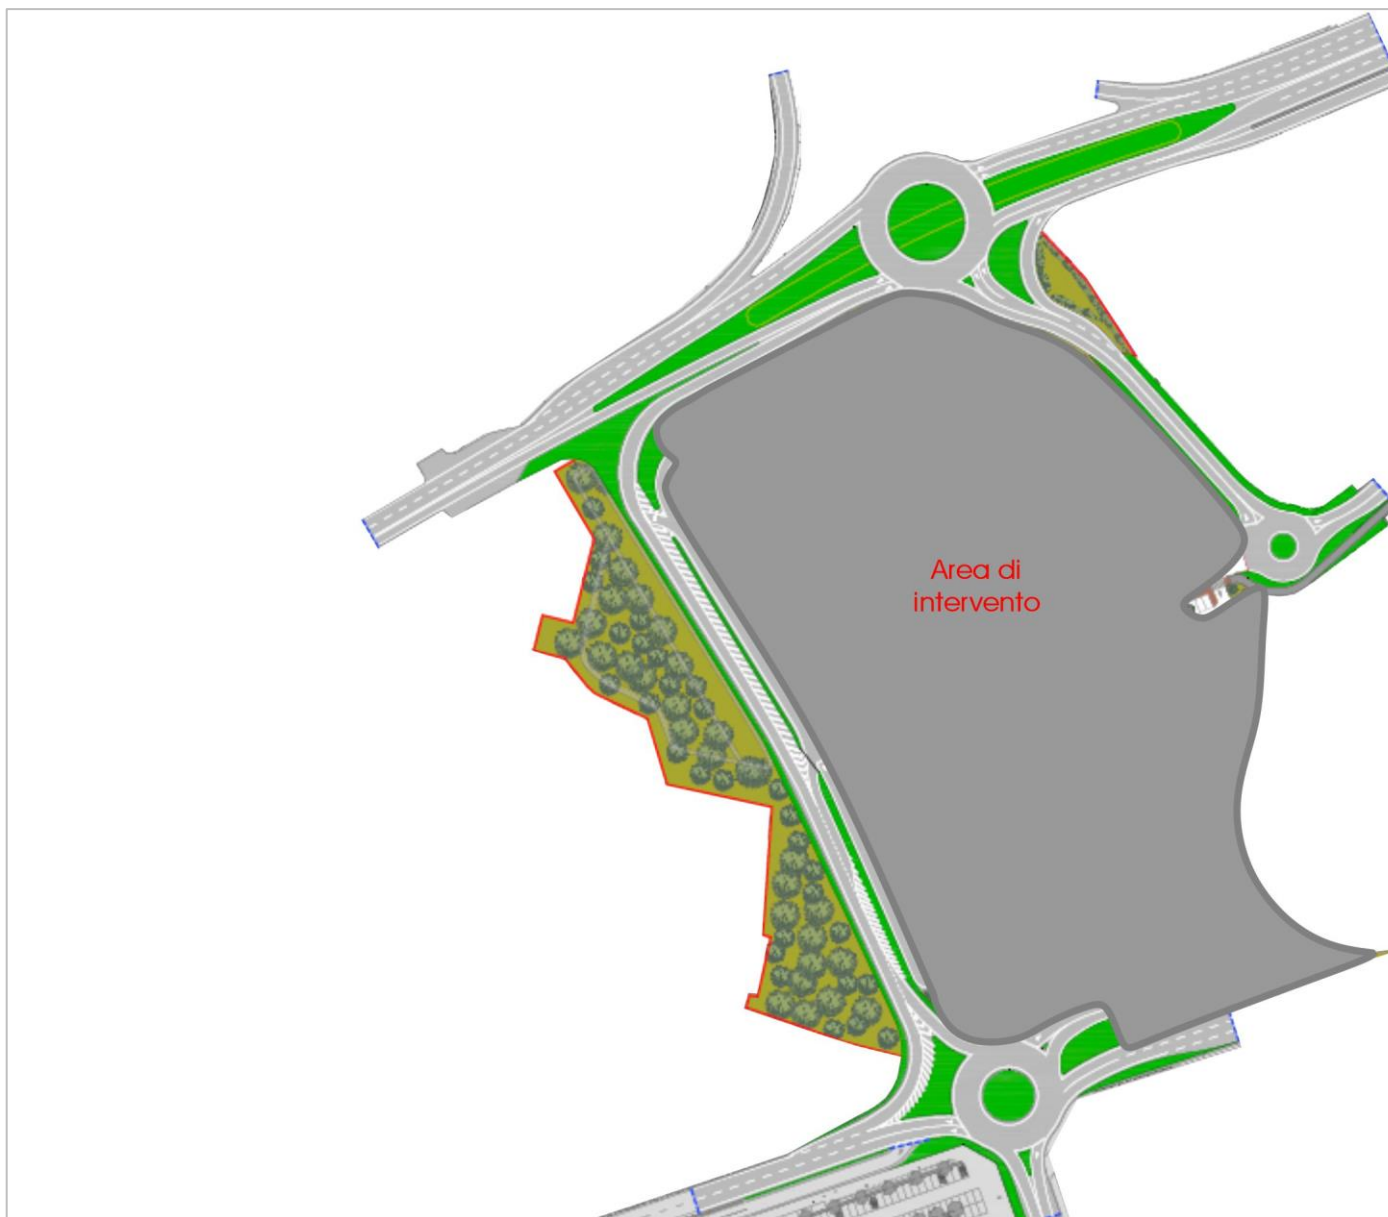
Interventi viabilistici previsti – Ipotesi 2 – Planimetria di progetto
